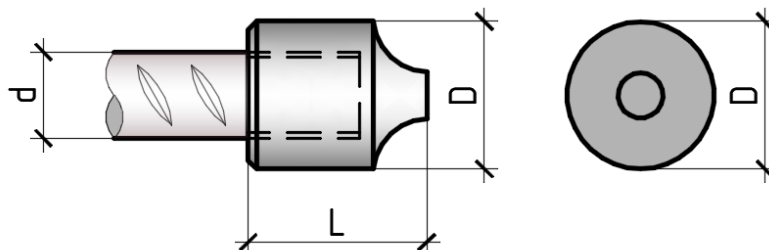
Муфты типа W сварных соединений K2-ARMTECH-P
